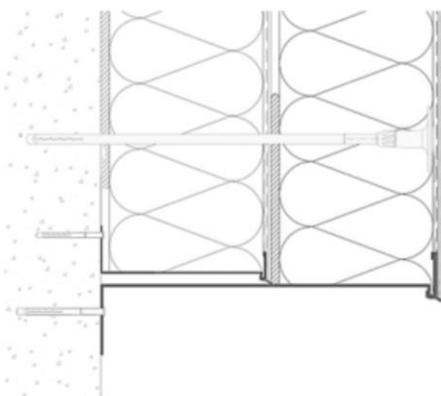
Traitement des points singuliers avec chevillage Baumit StarTrack – cas de la pose de bandes filantes
